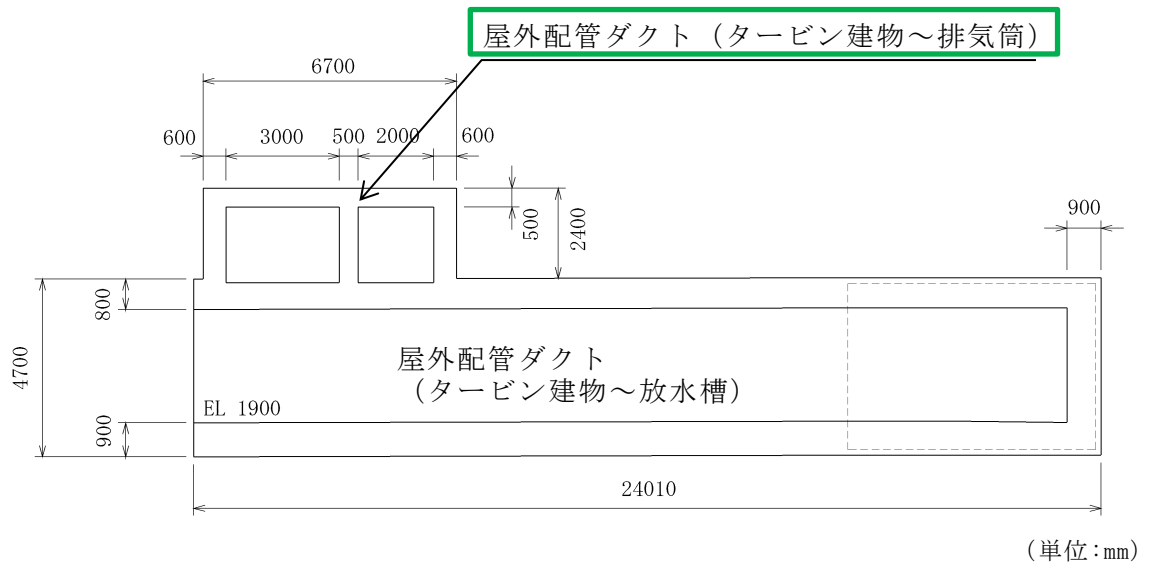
屋外配管ダクト（タービン建物～排気筒） 断面図（B-B 断面）
